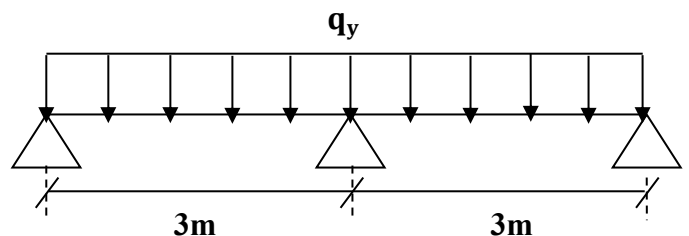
Actions sur la lisse de bardage dans le plan (Y-Y)
